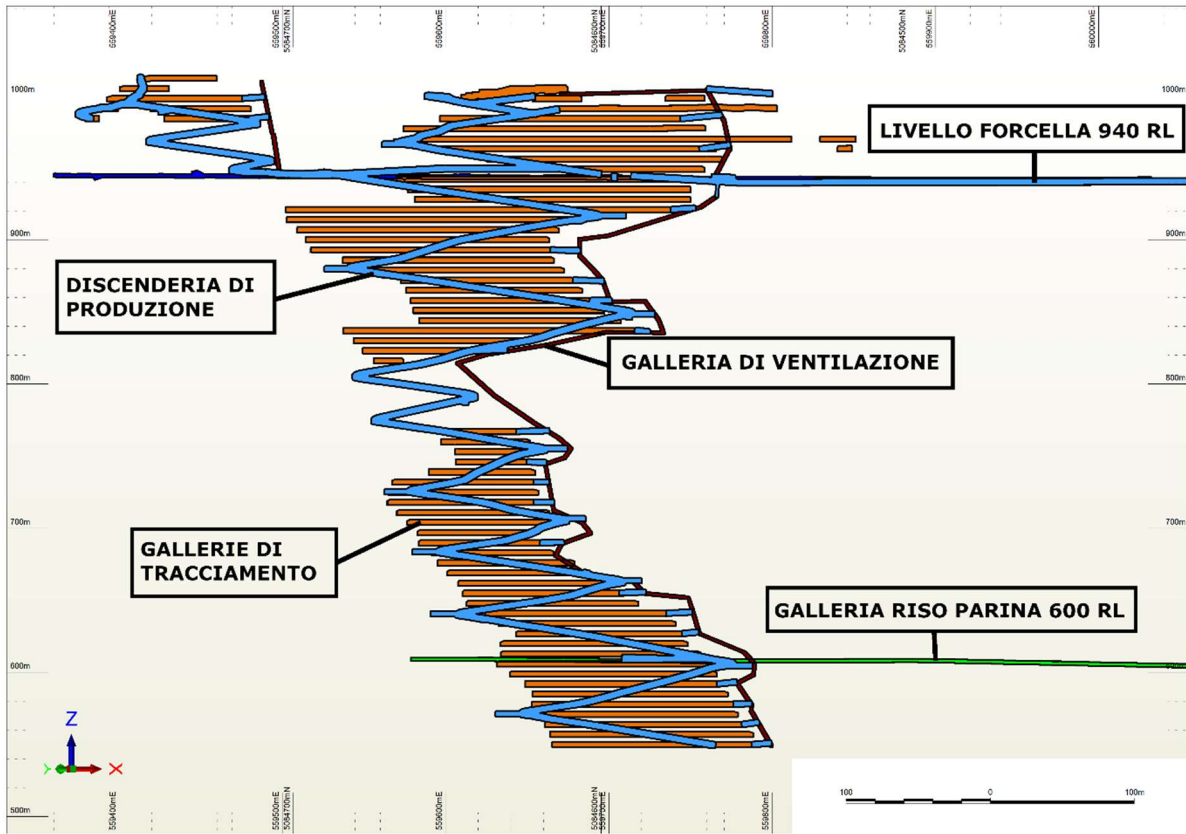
Sezione/prospetto della miniera, con gallerie di tracciamento e produzione
